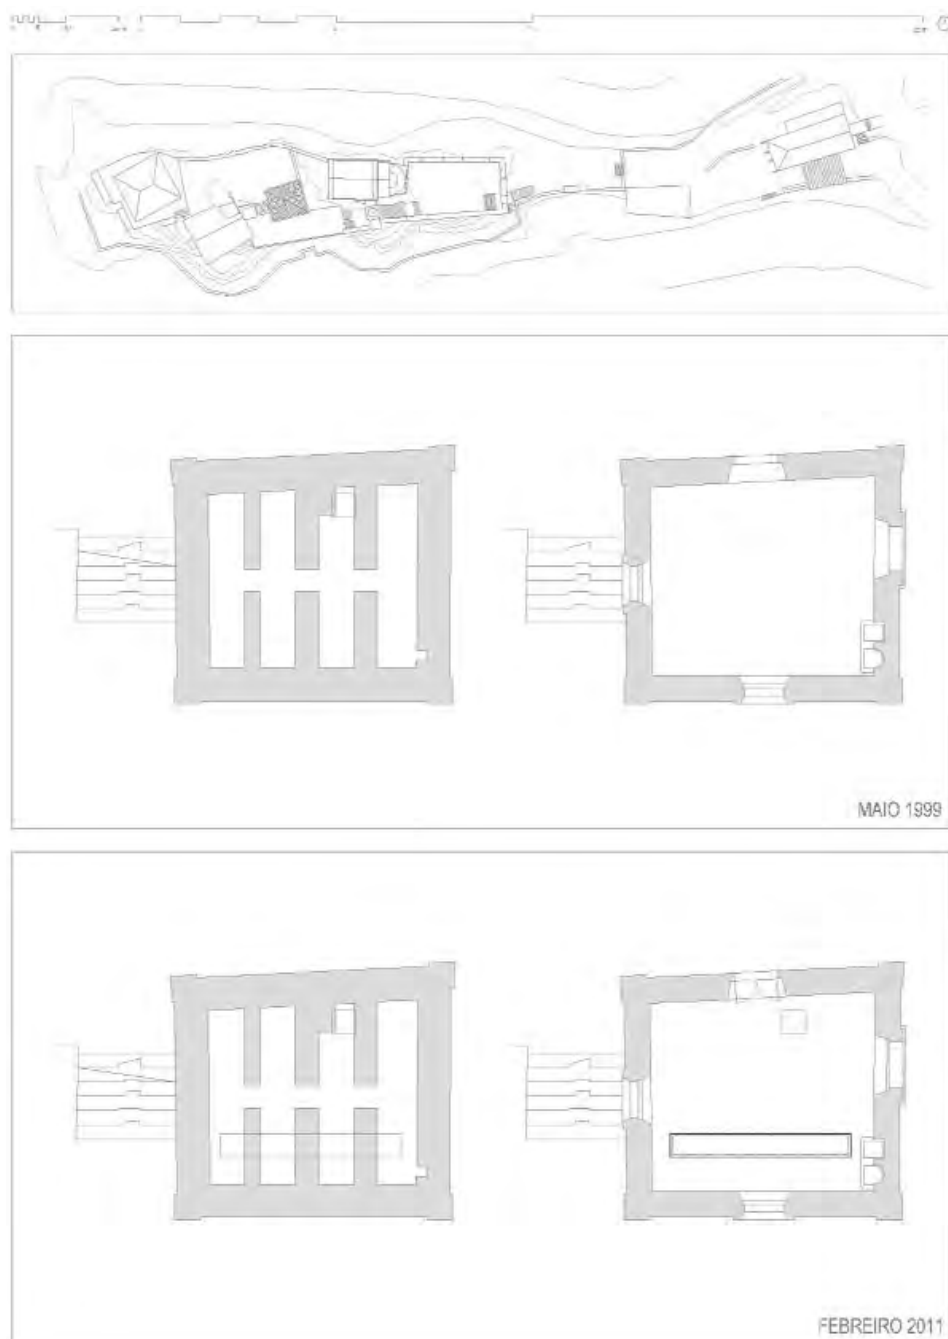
CAAVEIRO. Planta soto e de entrada da Sancristía (Pavillón de exposicións).
